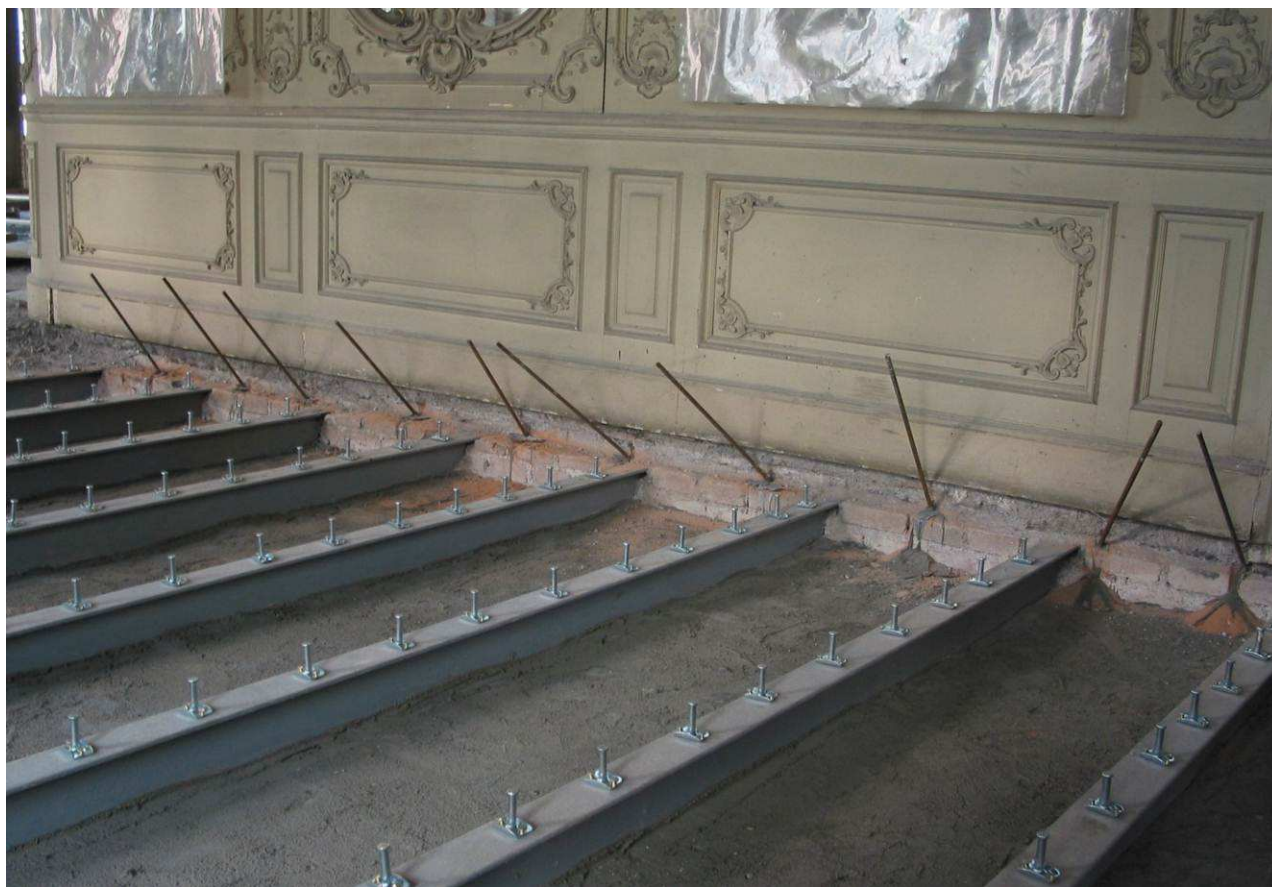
Solaio con travi in acciaio e interposti laterizi; sono presenti i connettori fissati alle travi e le barre di collegamento ancorate alle murature; successivamente seguirà livellamento con materiale di riempimento leggero, posa di rete elettrosaldata e getto del calcestruzzo.
